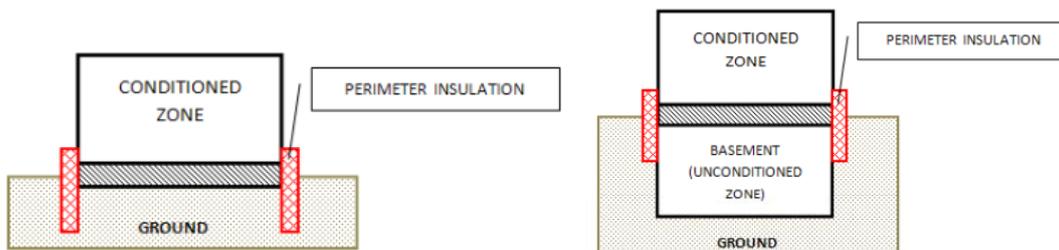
Aislamiento perimetral de solera o muro en contacto con el terreno
